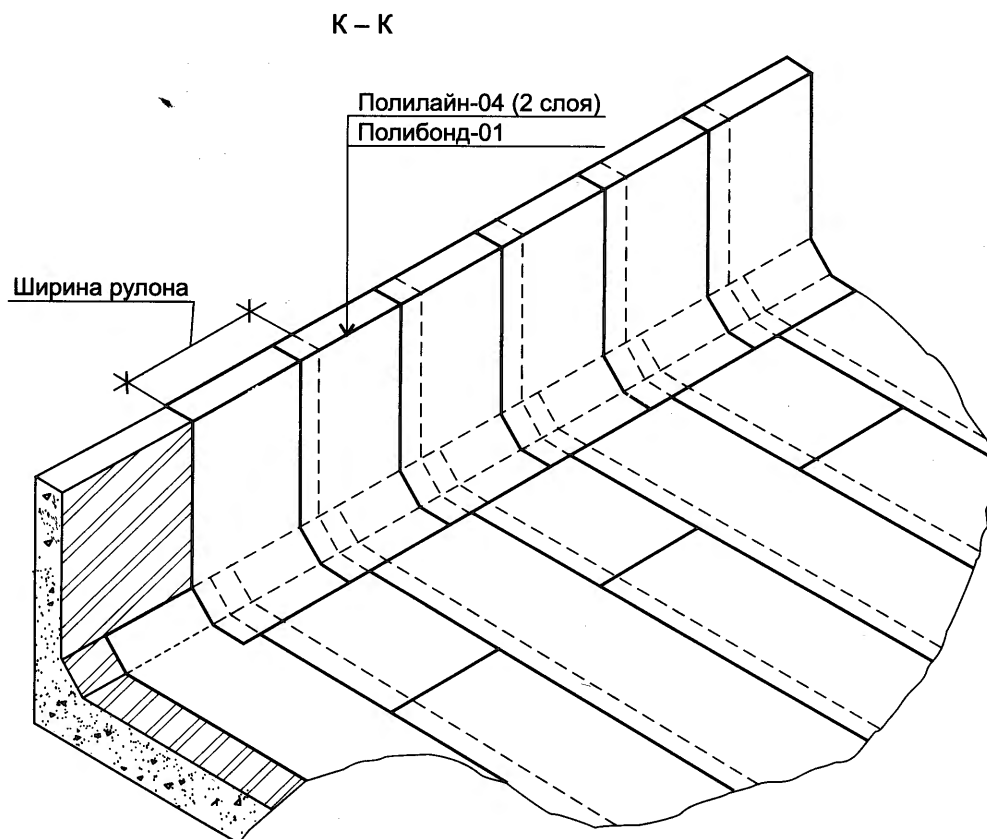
Схема восстановления гидроизоляции кровельного ковра
